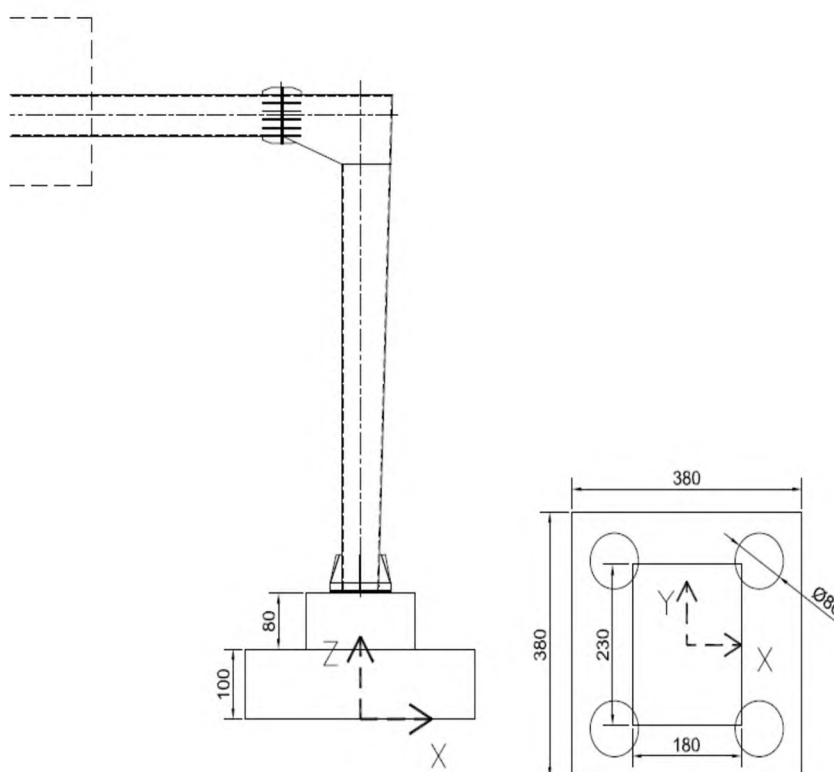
Carpenteria del plinto di fondazione - Posa su terreno pianeggiante
